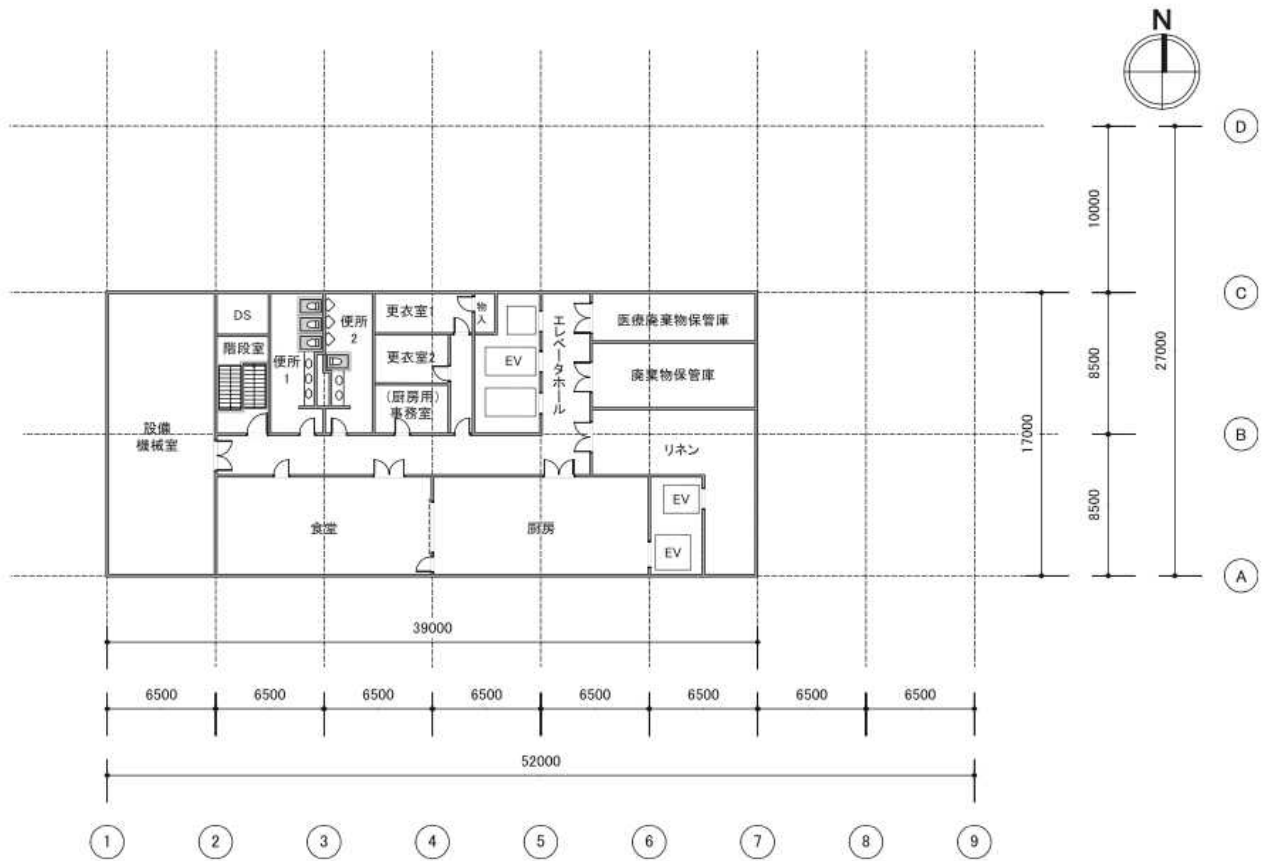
6 モデル建物（総合病院等） 地下 1 階平面図
